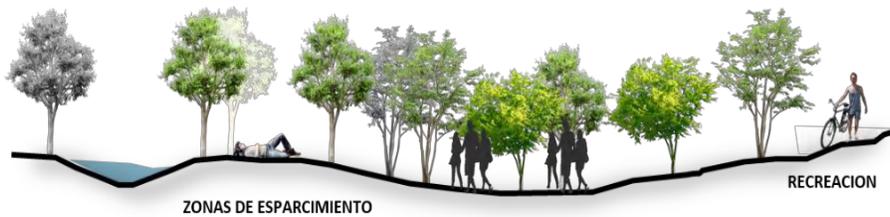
Propuesta de zonas de protección. Fuente: Esta Investigación
